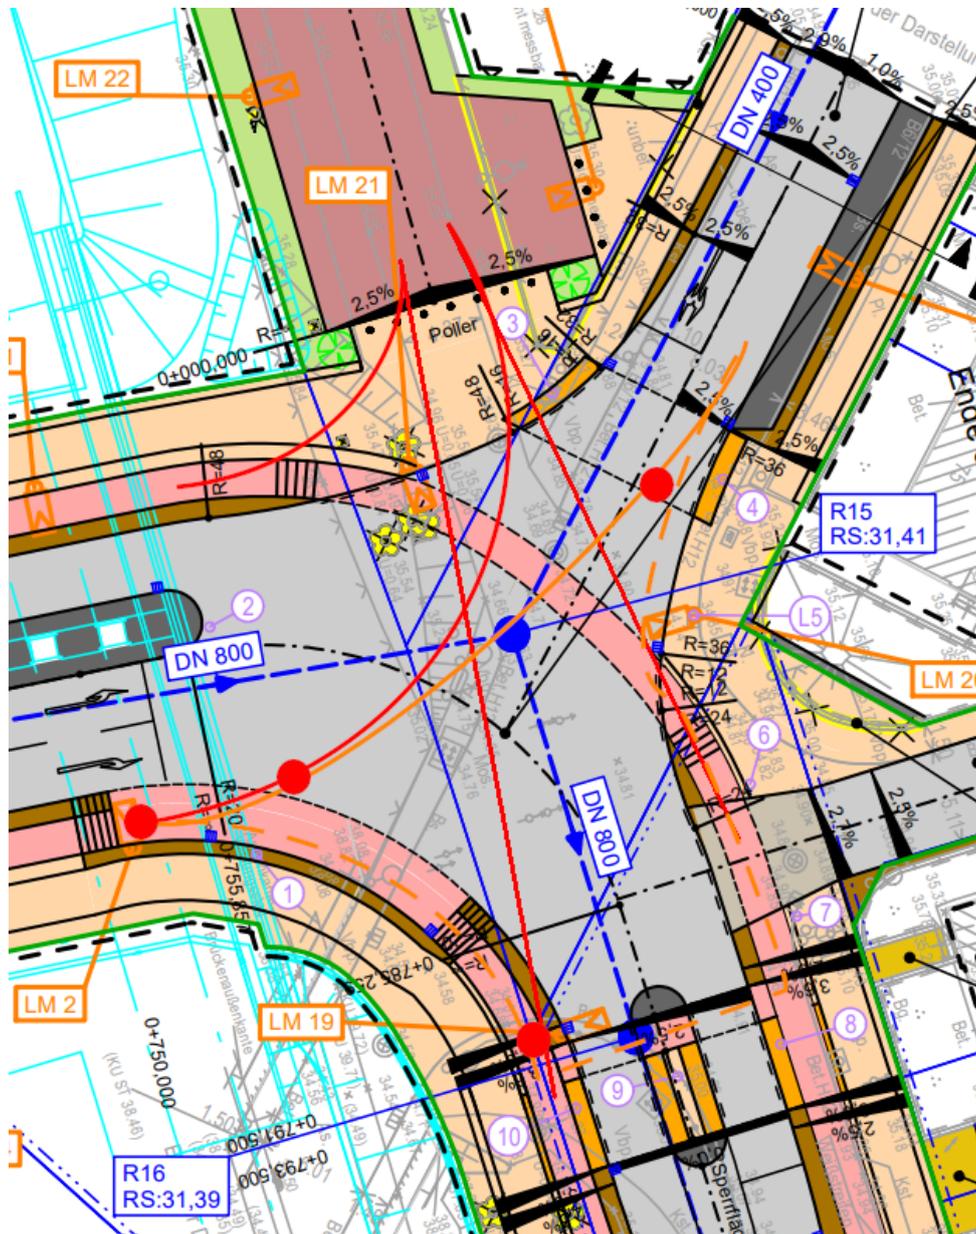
Unberücksichtigte Wegbeziehungen und Konfliktpunkte (rot) sowie unnatürliche Wegführungen (orange) im Knotenpunkt Hämmerlingstraße nach Planungsunterlagen Lageplan Bau-km: 0+390,000 - 0+850,000.
